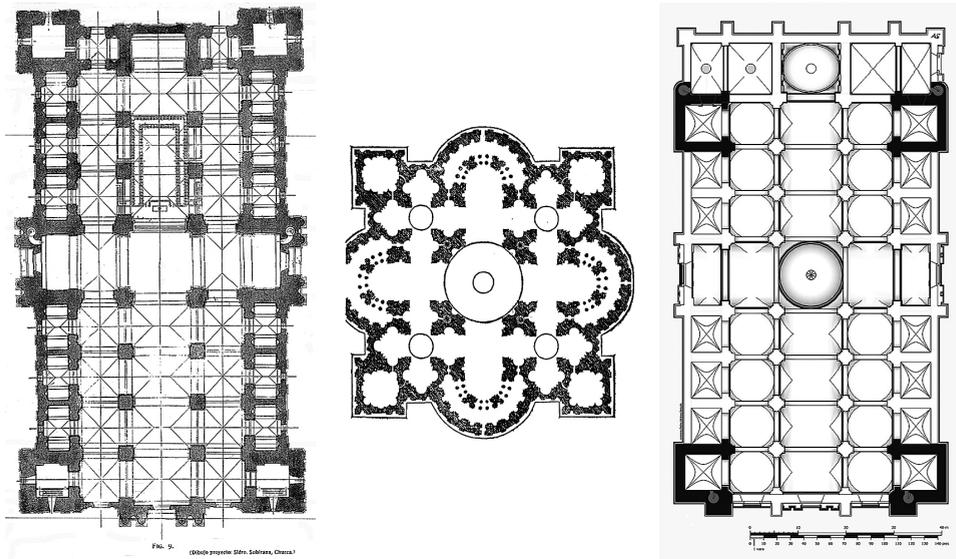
, 13 Y 14. *Planta de la catedral de Valladolid, planta de San Pedro del Vaticano por Bramante y planta de la catedral de Puebla*<sup>52</sup>.
